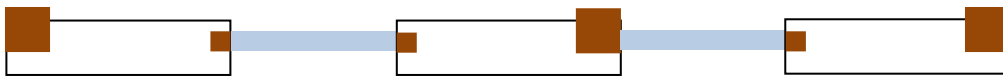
c-5 - Corte transversal de la pared norte de la planta alta
